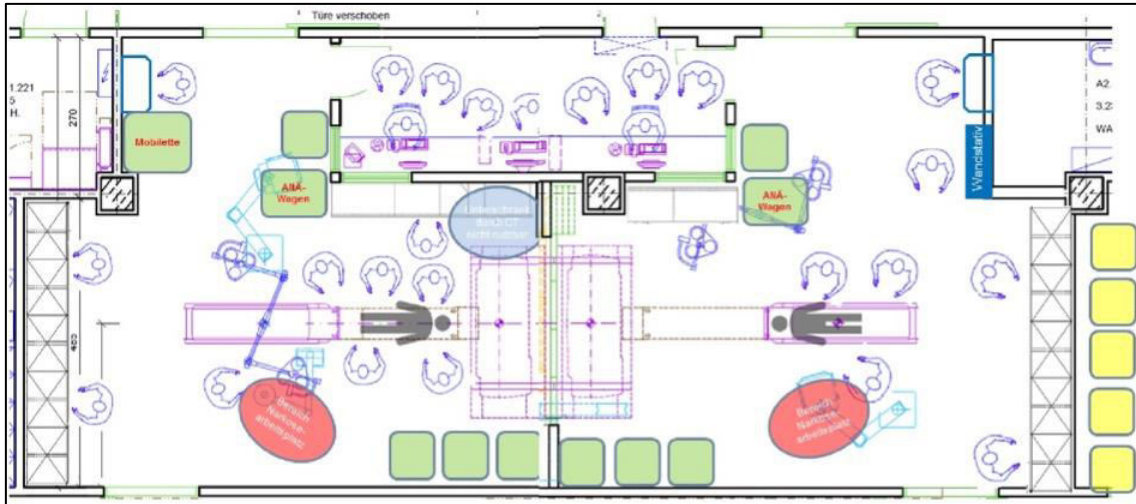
Grundriss des Würzburger Doppelschockraumes (80).
